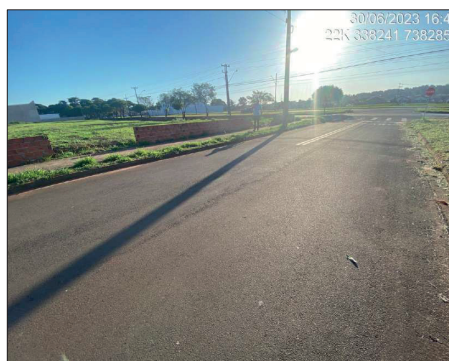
Pavimentação asfáltica da Travessa Almerindo Duarte
